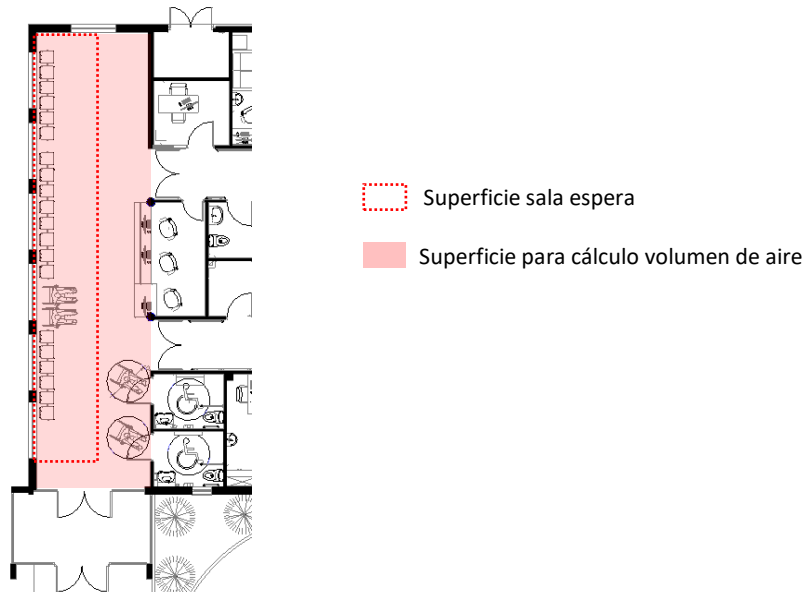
Planta arquitectura SAR Boca Sur con superficies
